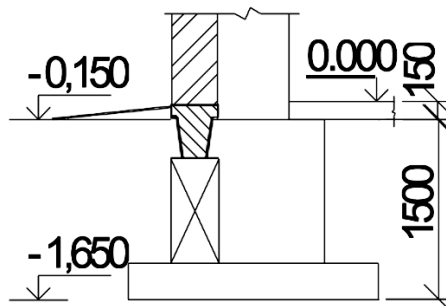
Конструкція фундаменту на перетині осей А і 3
